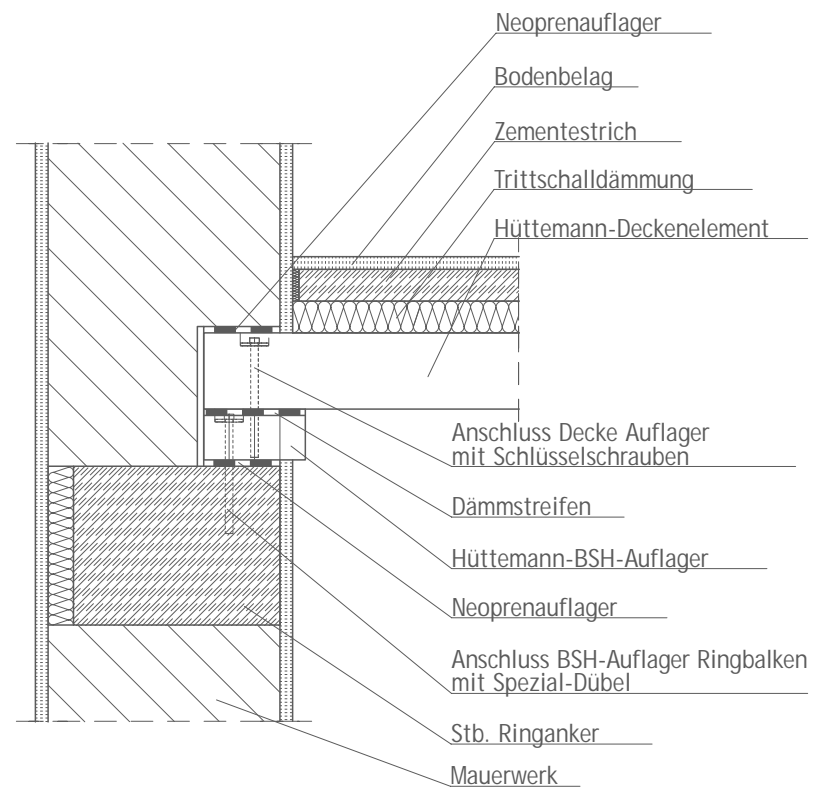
ANSCHLUSS DECKENELEMENT-WANDELEMENT
